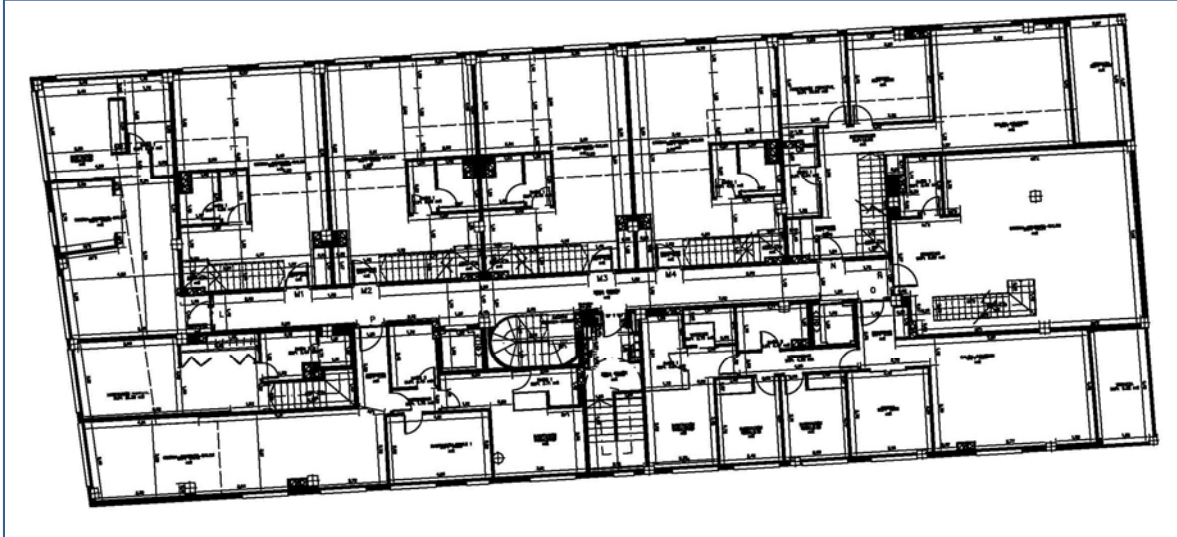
Plano de planta segunda. Procede del Proyecto de Ejecución.
